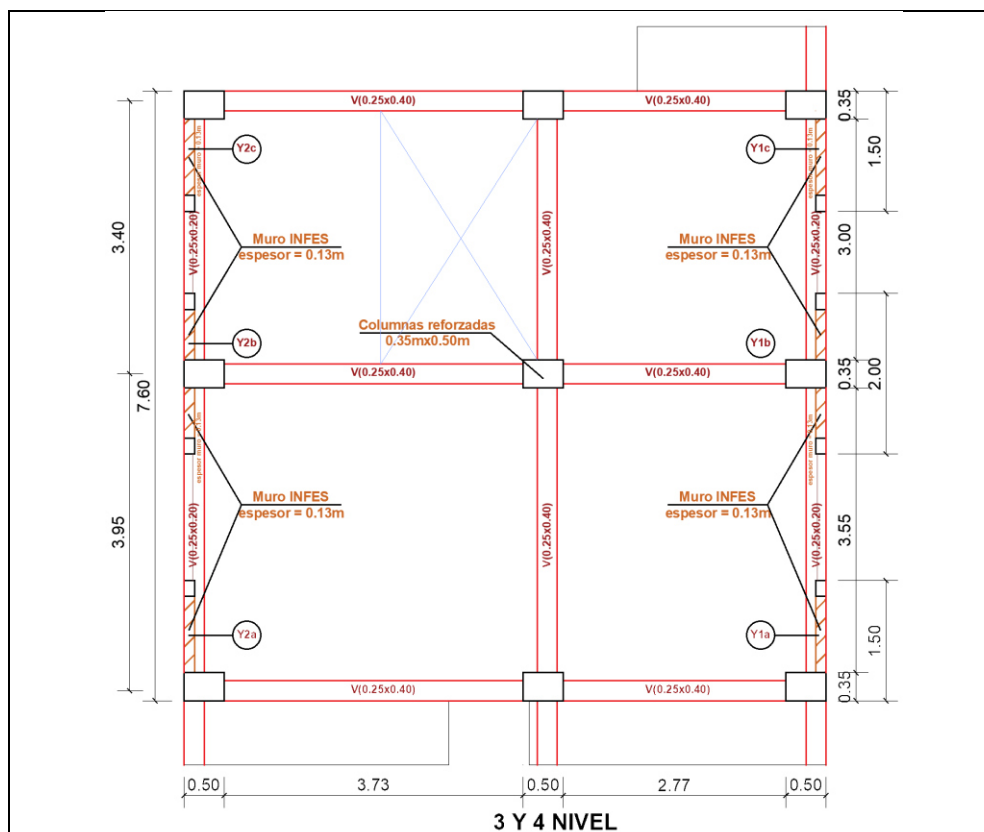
Planta 3er y 4to nivel de segunda propuesta de reforzamiento.
